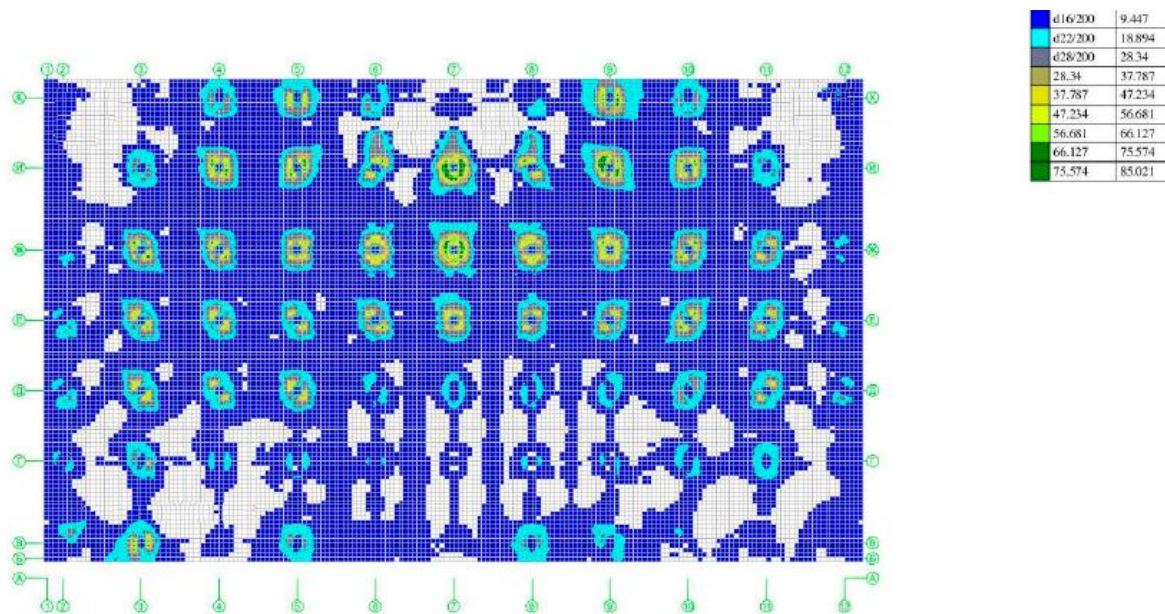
Расчет подбора арматуры плиты фундамента
